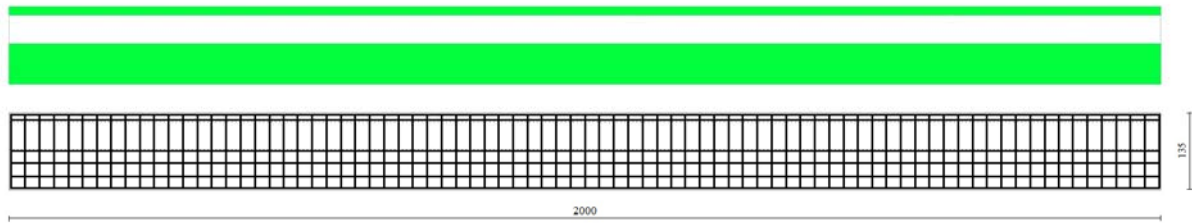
Piastra fondazione dir. X (Inviluppo)
